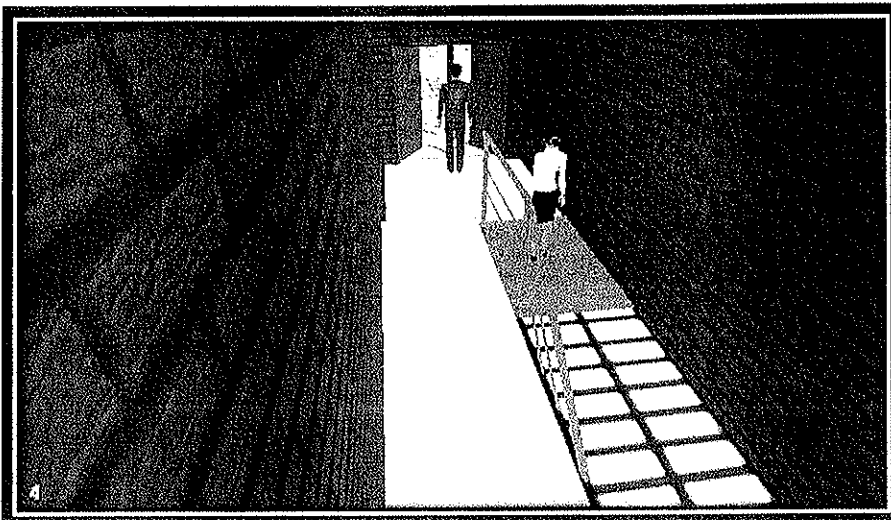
Vista de la Salida de Emergencia Tipo 2
